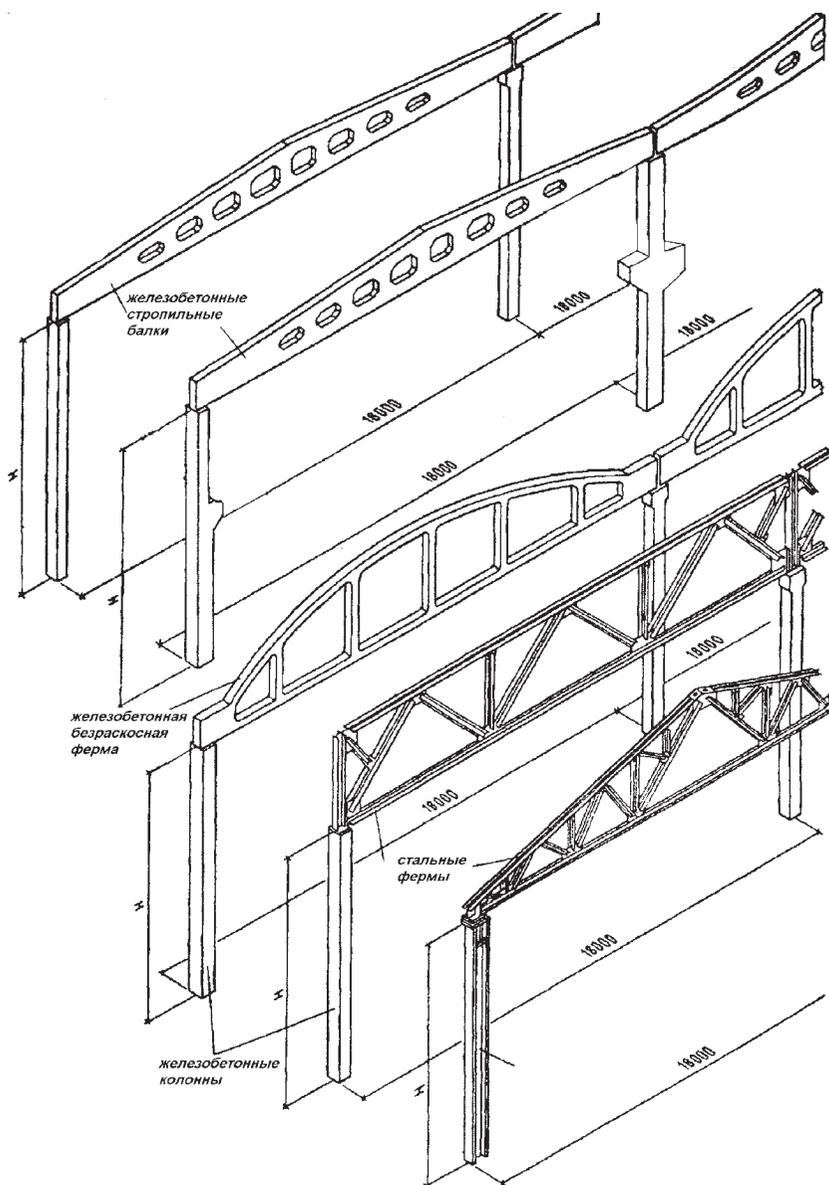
Унифицированные типовые конструкции одноэтажных производственных зданий
